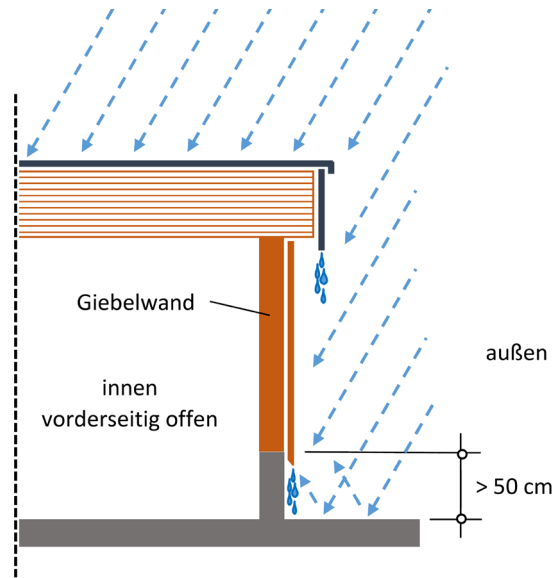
Vertikalschnitt durch die Giebelaußenwand einer offenen Halle
